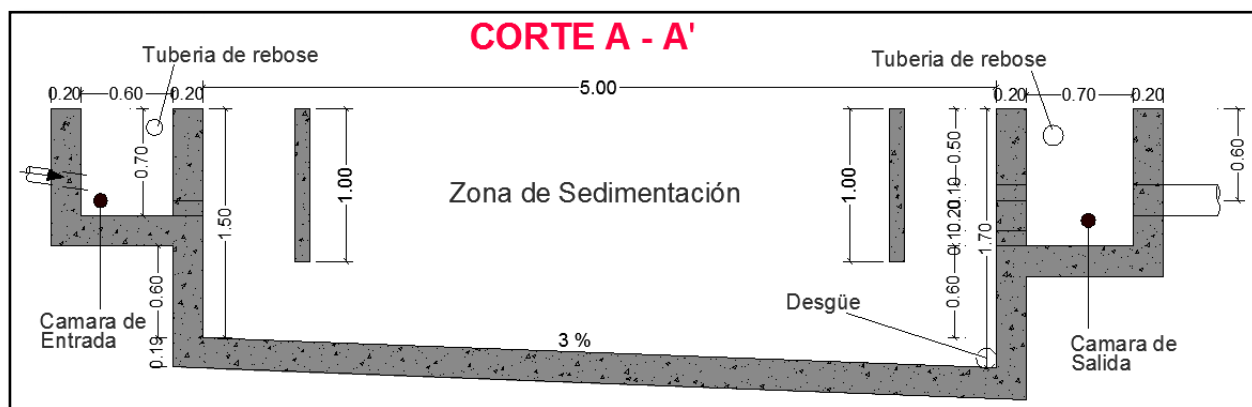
Sección transversal del desarenador existente. Fuente: Autores del proyecto.
